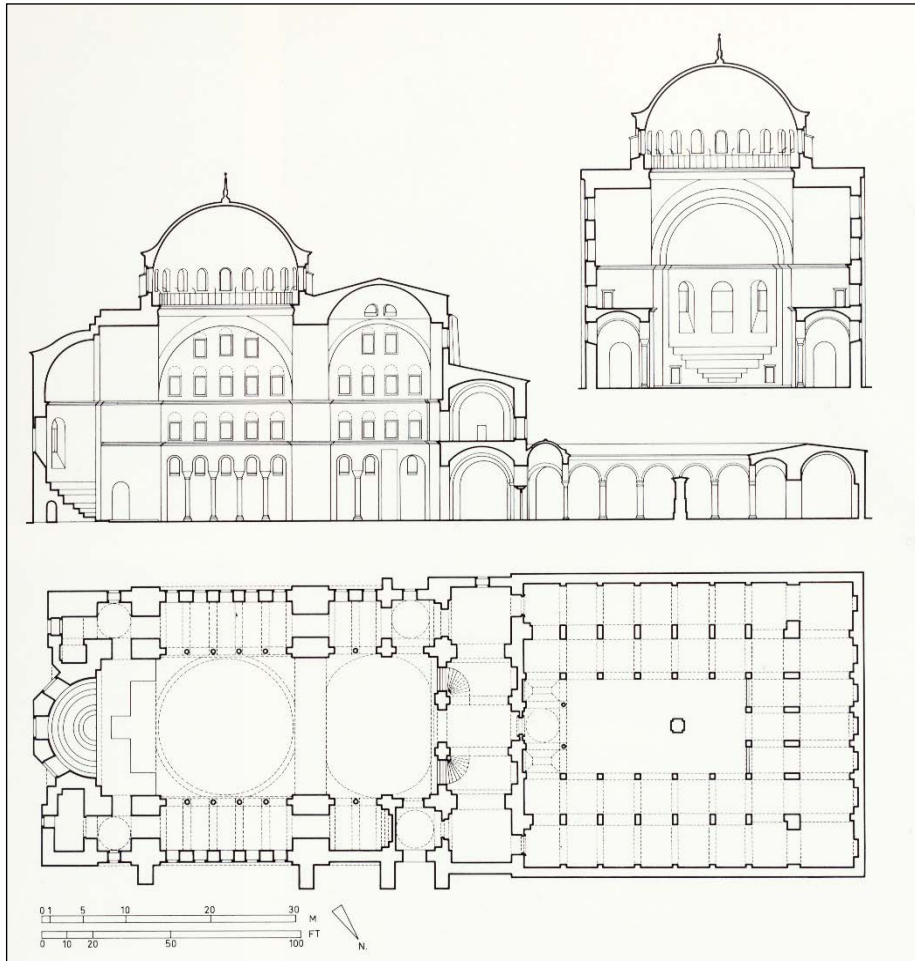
Hagia Irene, Längs- und Querschnitt, Grundriss
